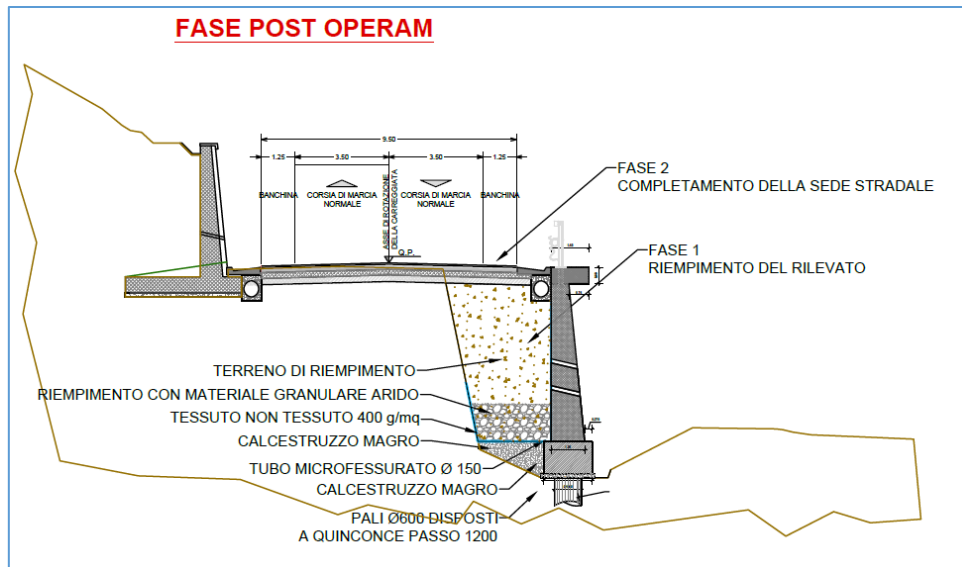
d–Sezione tipo 2 – Fase post operam
